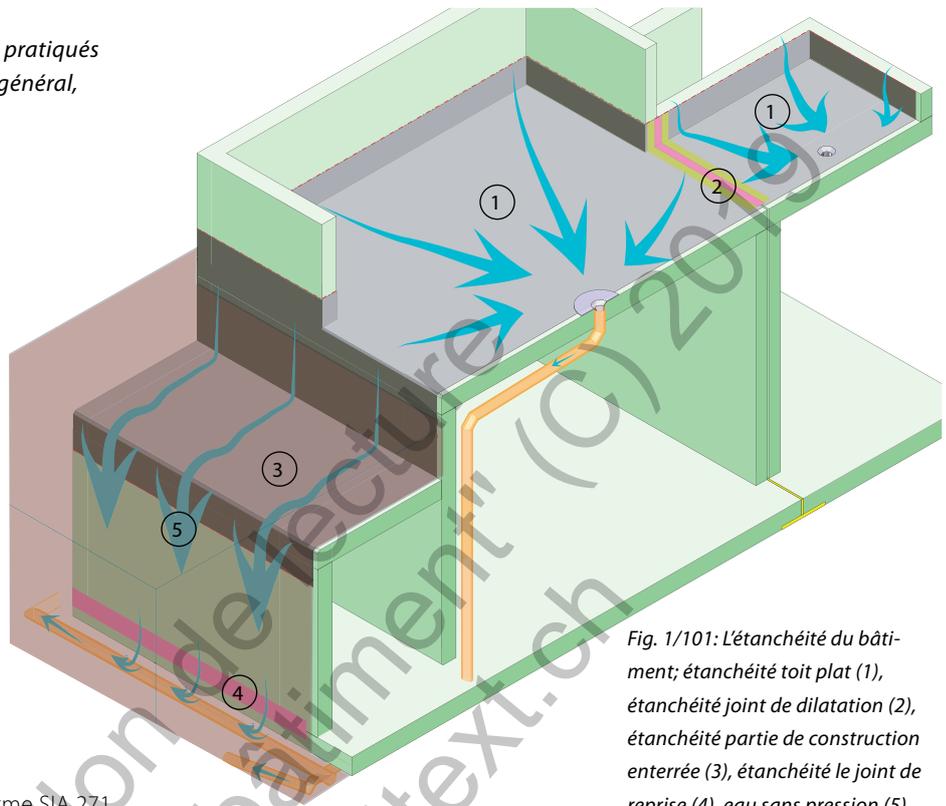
/101: L'étanchéité du bâtiment; étanchéité toit plat (1), étanchéité joint de dilatation (2), étanchéité partie de construction enterrée (3), étanchéité le joint de reprise (4), eau sans pression (5)
